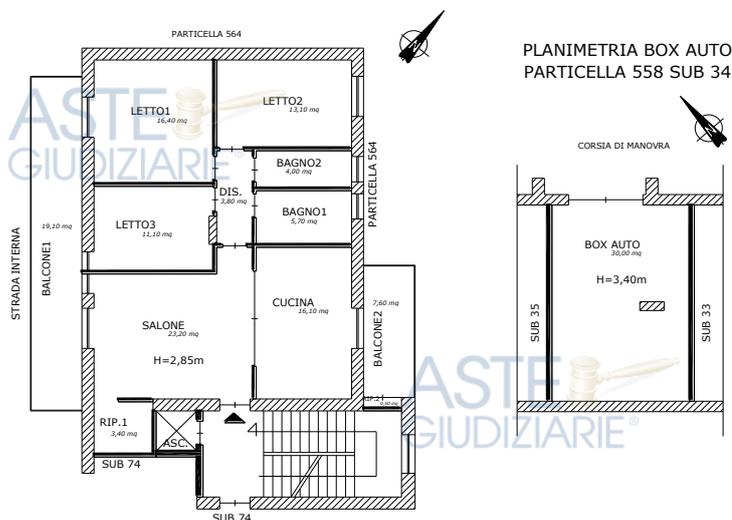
planimetria dell'appartamento al quarto piano e del box auto al piano interrato
